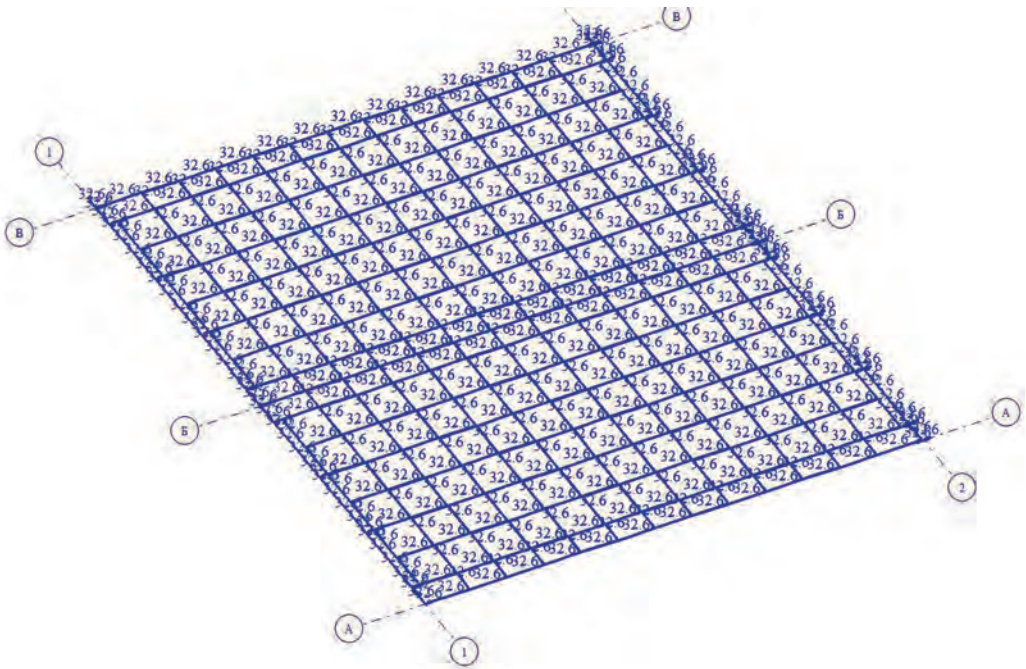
Фрагмент перекрытия типового этажа с температурной нагрузкой в теплое время года.
